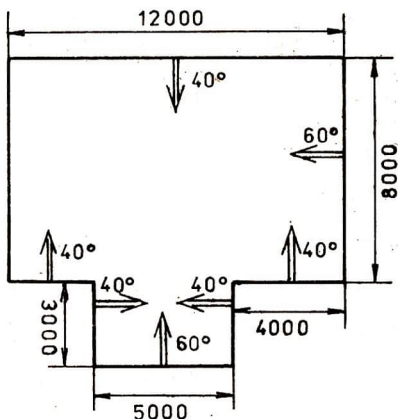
Grundriß eines Daches mit Neigungswinkeln der Dachflächen
